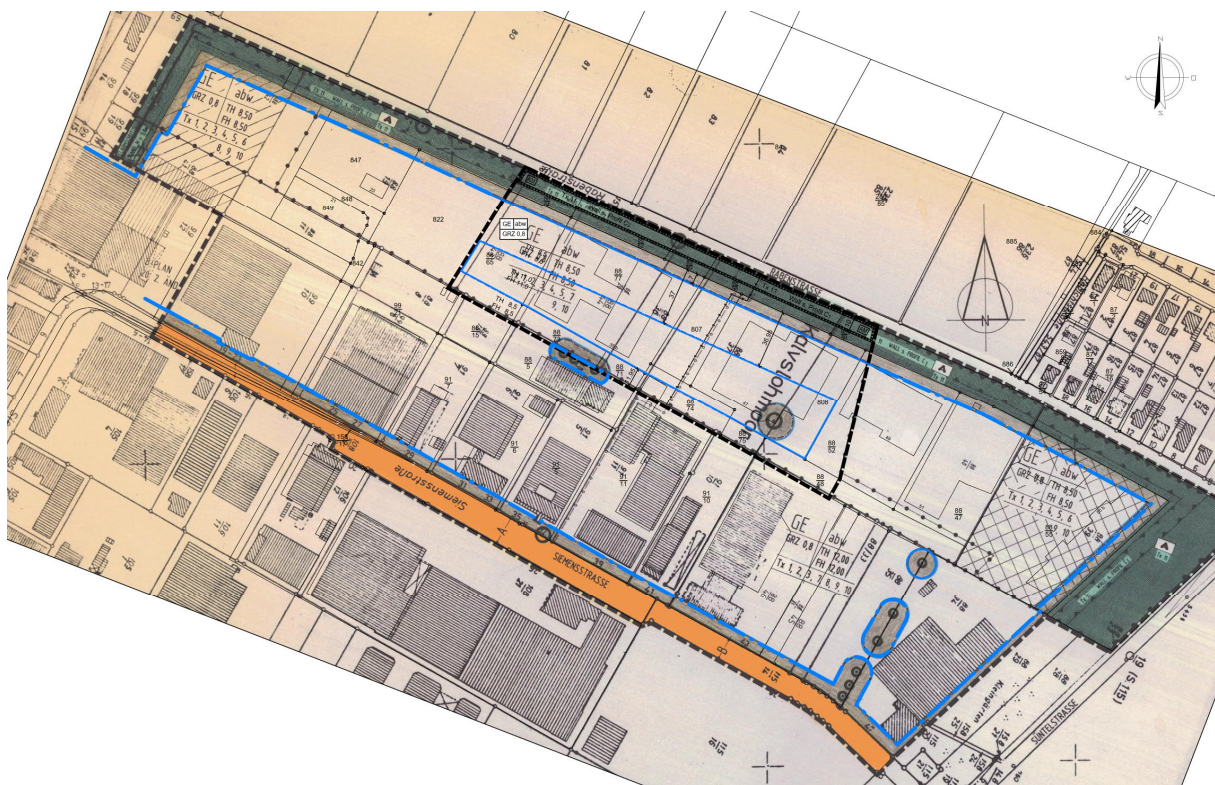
Original-B-Plan Nr. 54 mit Überschneidung der 1. Änderung (Planzeichnung)
